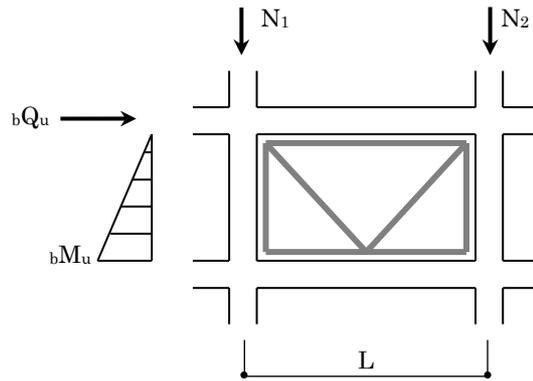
鉄骨ブレース架構の曲げ耐力 (bM_u)
